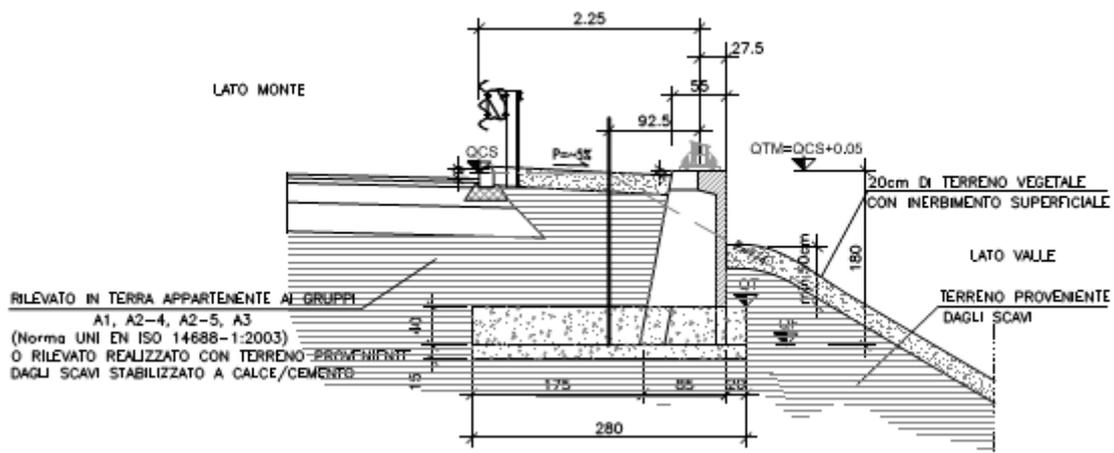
Tipologico muro H=1.80 m porta FOA su fondazione diretta
